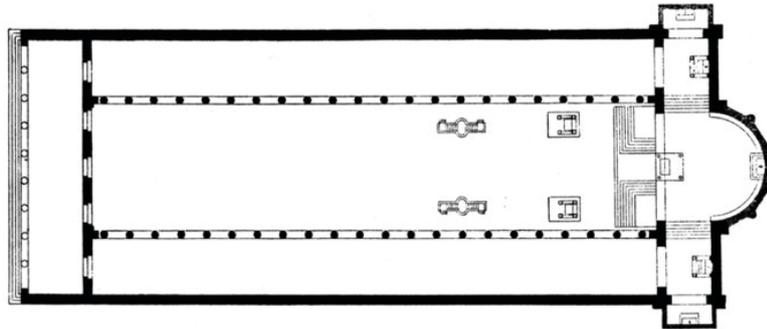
Grundriss der Basilika Santa Maria Maggiore
